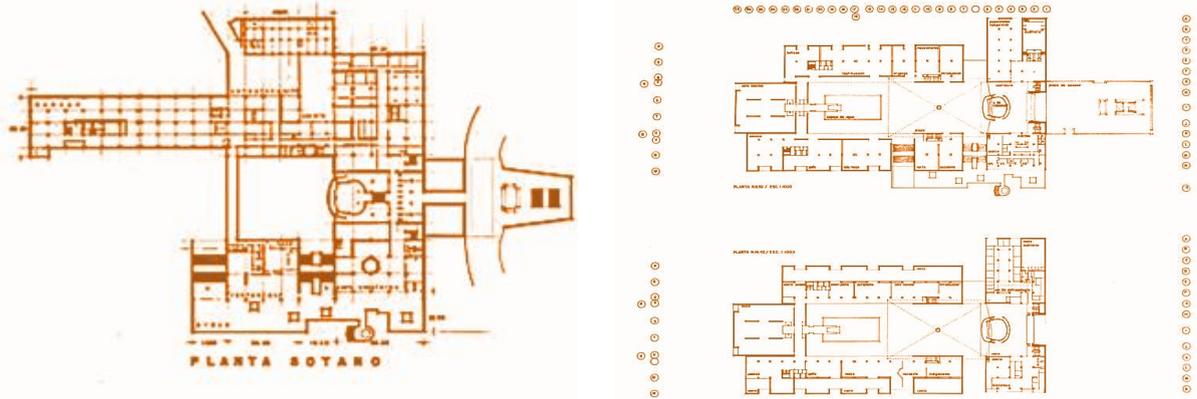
Planos arquitectónicos del M.N.A. a la izquierda se encuentra la planta del sótano, en la parte superior derecha, la planta baja con el vestíbulo y las salas de arqueología y, en la parte inferior la planta alta de las salas de etnografía. Fuente del archivo fotográfico del arquitecto Pedro Ramírez Vázquez
